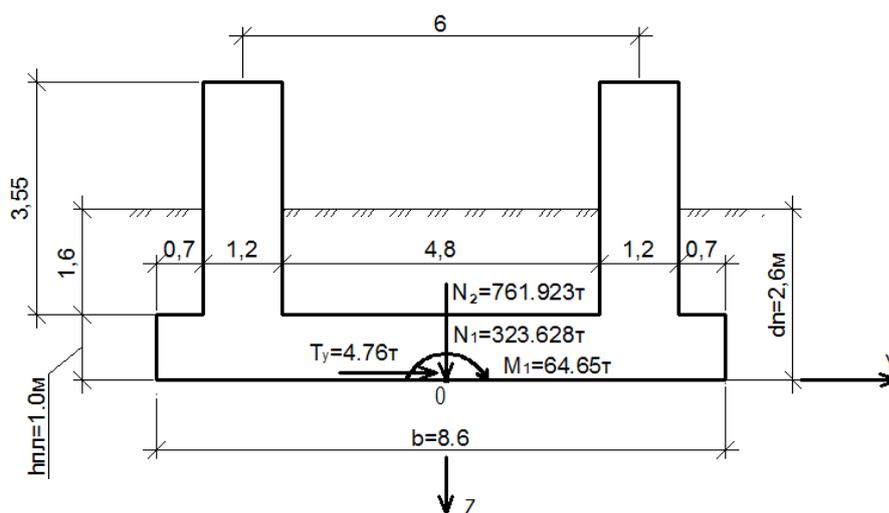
Расчетная схема для определения давления на подошвы фундамента
